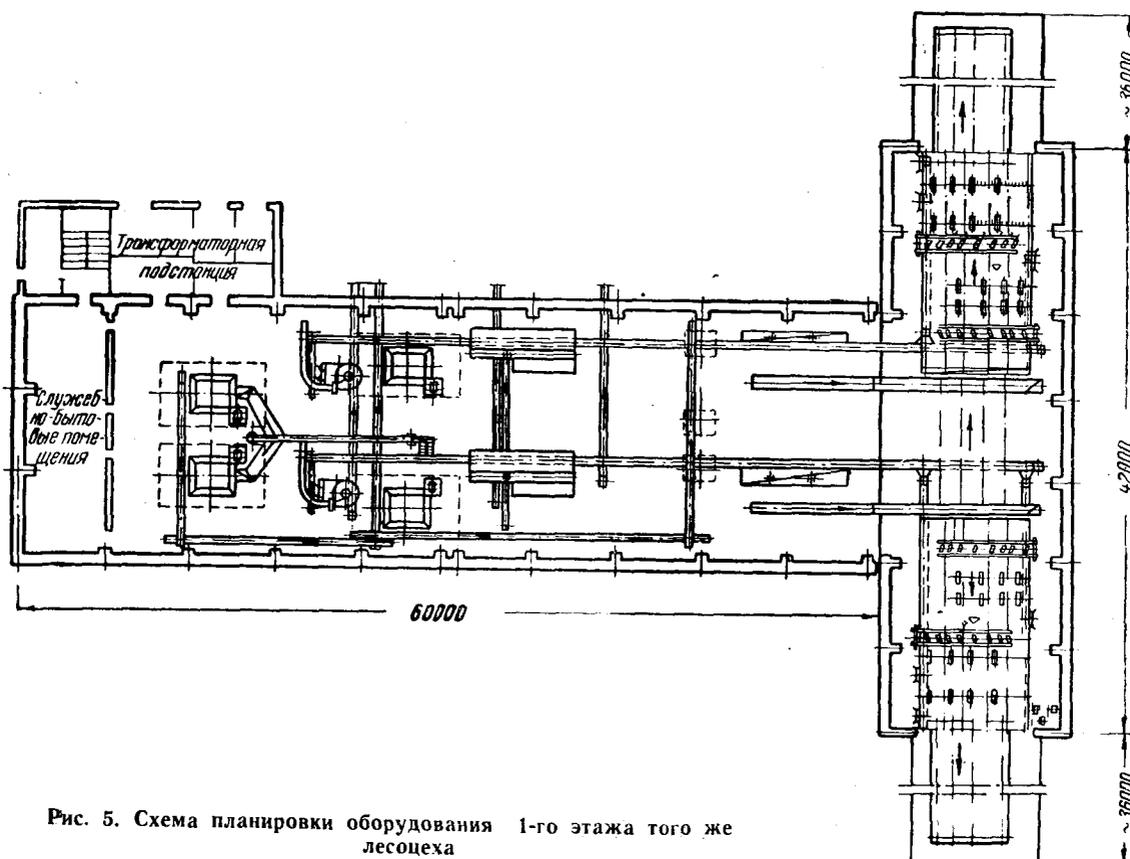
Схема планировки оборудования 1-го этажа того же лесопеха
